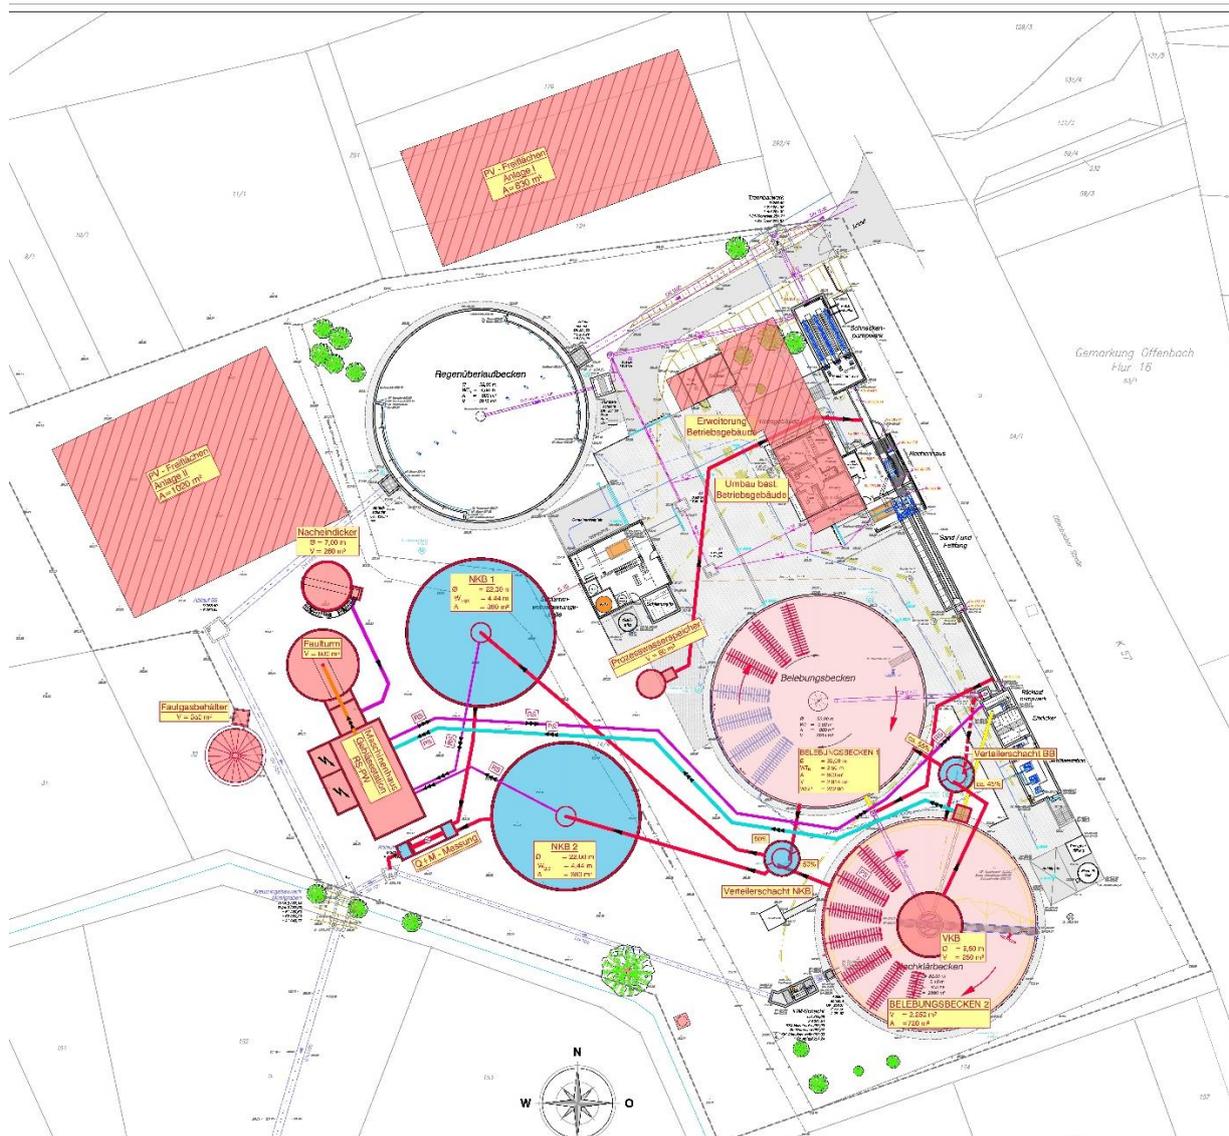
Vorplanung der Variante 2. Erweiterung der Kläranlage, Stand April 2024
